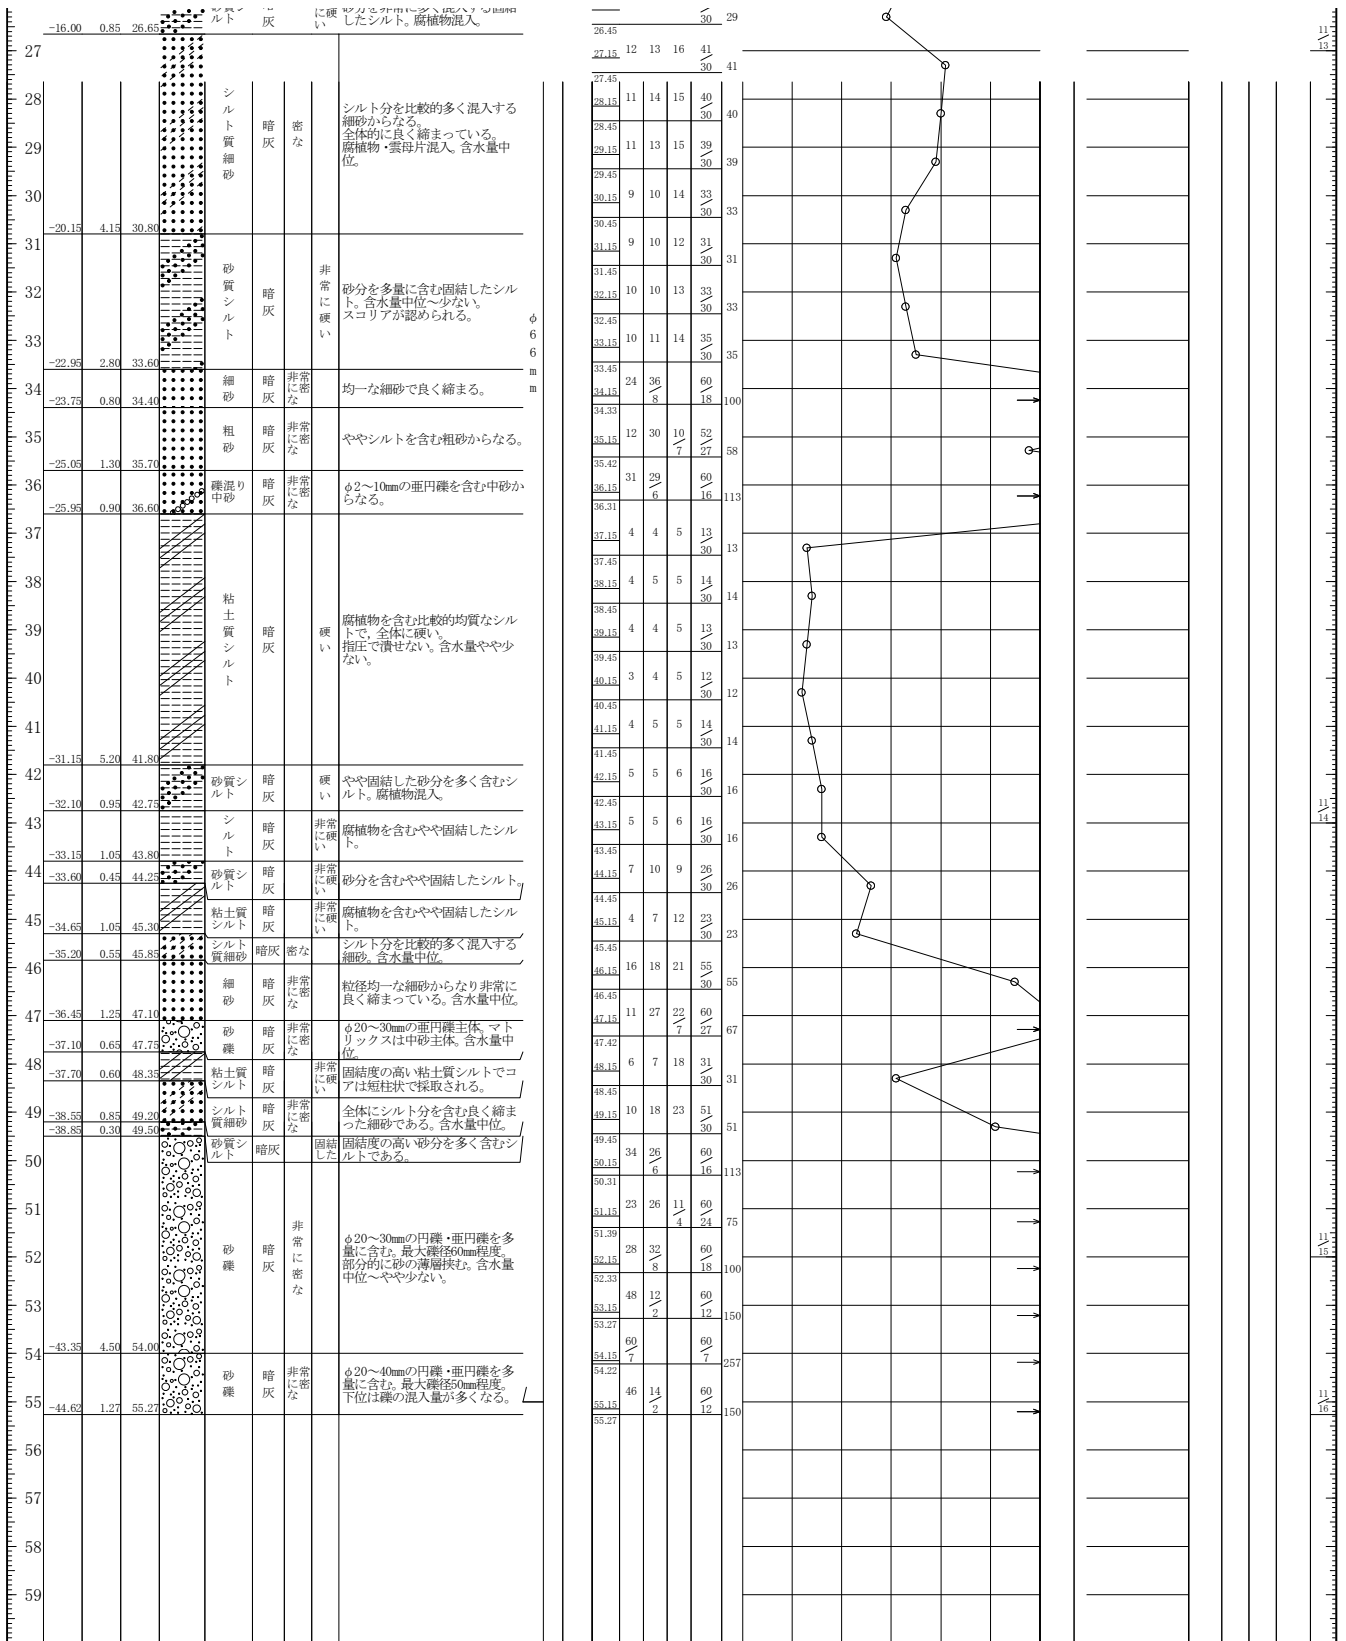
(2) ボーリング柱状図 (No.6-2)
